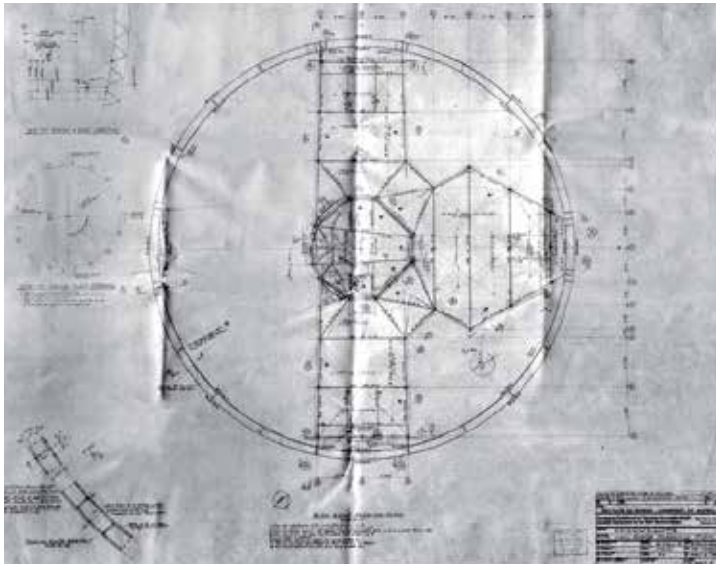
Markson, Morley e Instituto de Diseño de Waterloo: Planta del Pabellón Caleidoscopio, 1967.
